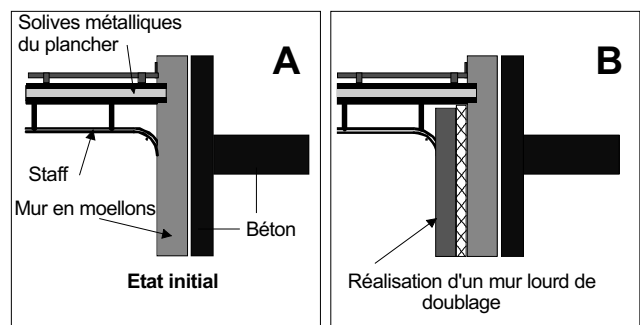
Détail de la jonction des planchers au mur mitoyen – A état initial – B après une première intervention
